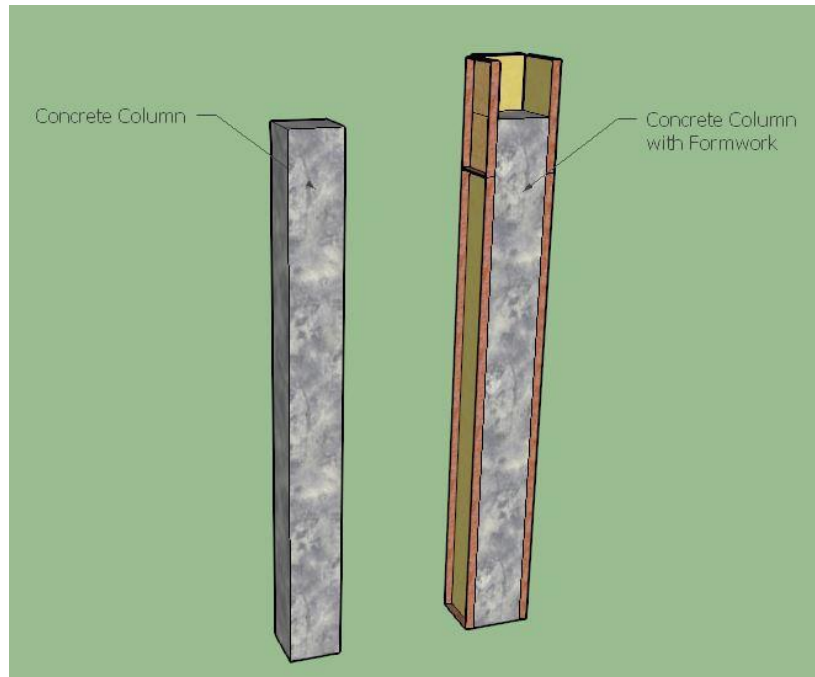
Columna de concreto reforzado aislada representada con y sin la selección final de elementos de encofrado modular.
